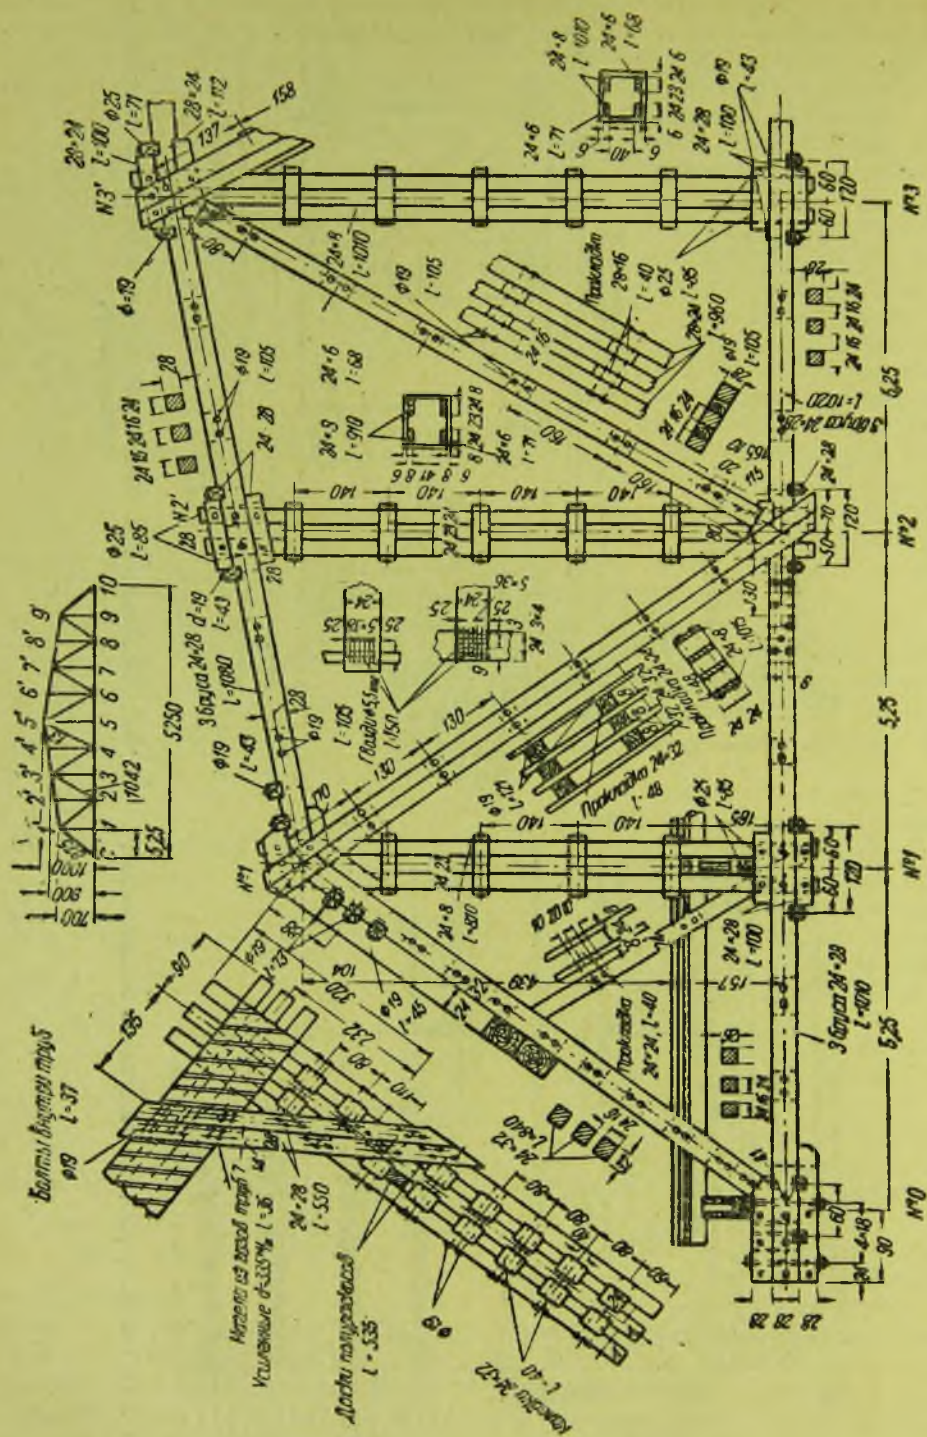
Размещение гвоздей в вертикальной стенке дощатой фермы.
